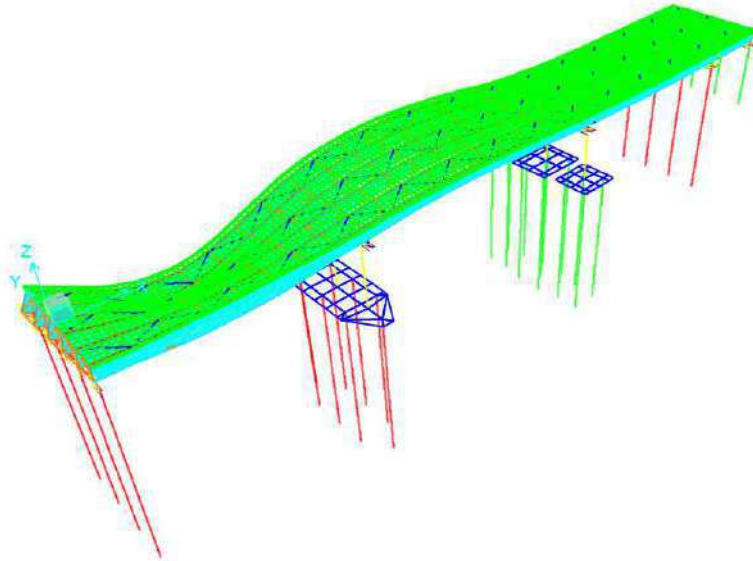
Deformada por efecto de la carga, Prueba 1 – 1Camión (P1C1).
